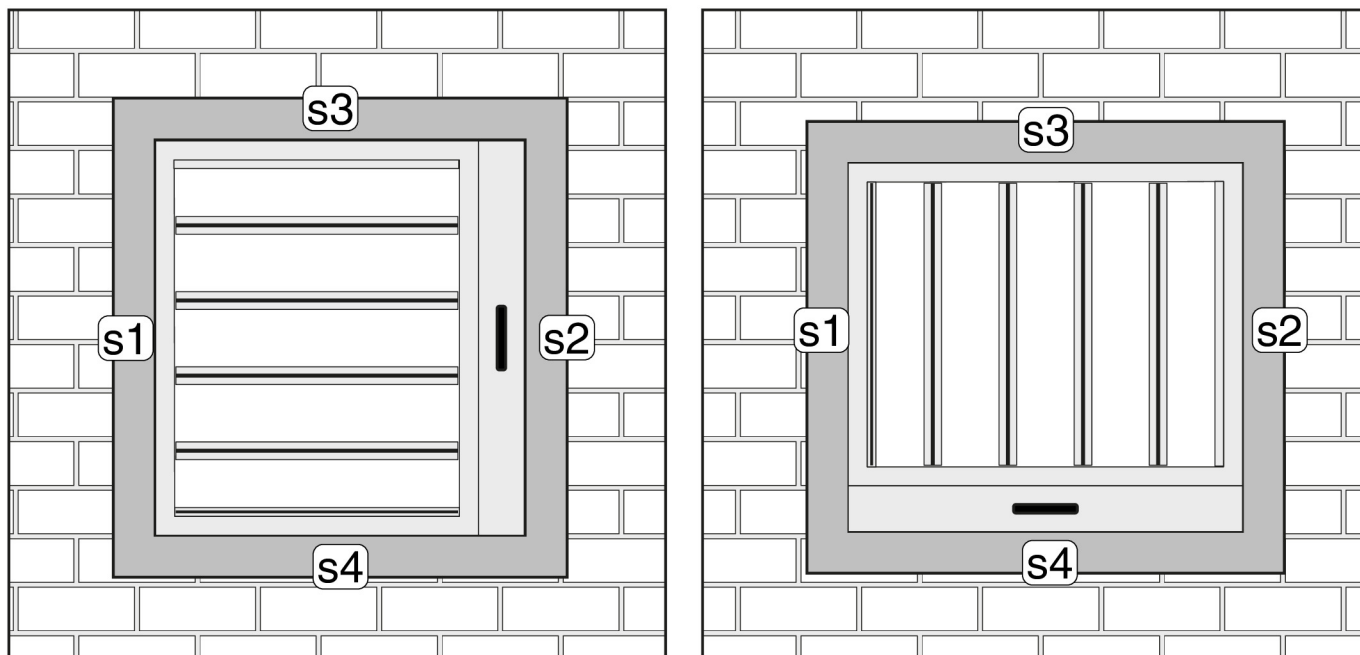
EK-JZ Einbauspaltvarianten für Massivwände
